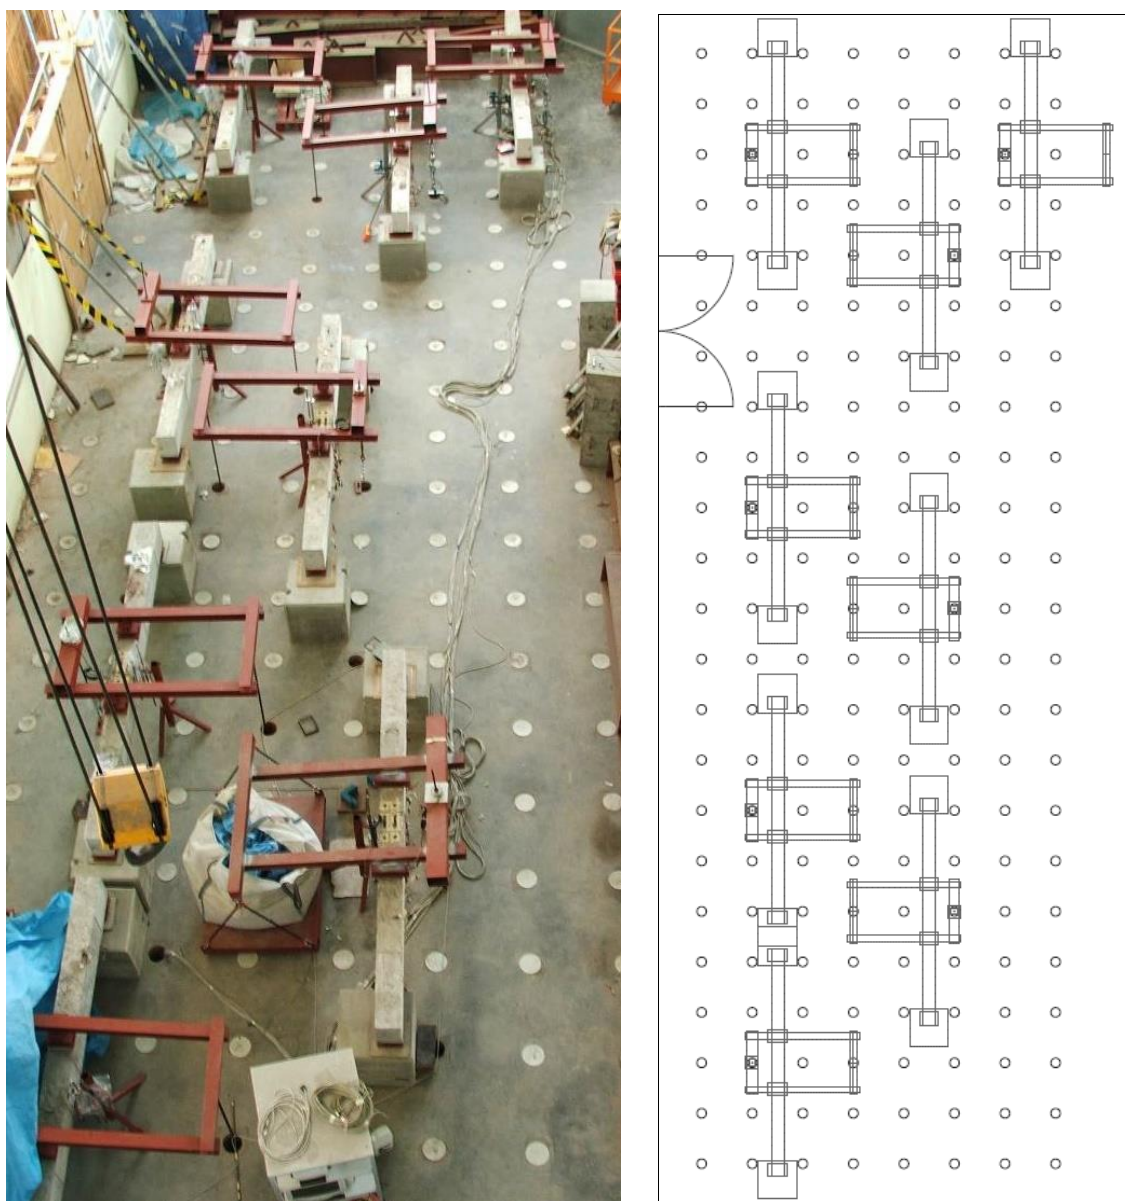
Distribución en planta del sistema de ensayo bajo carga sostenida. Fase Vistas II
